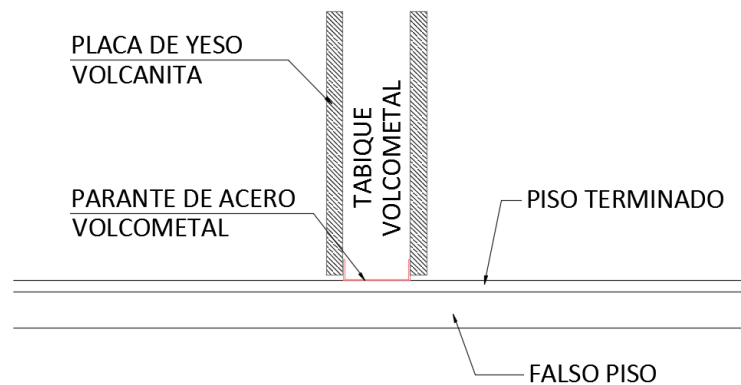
Detalle de encuentro entre tabiquería de drywall y piso
